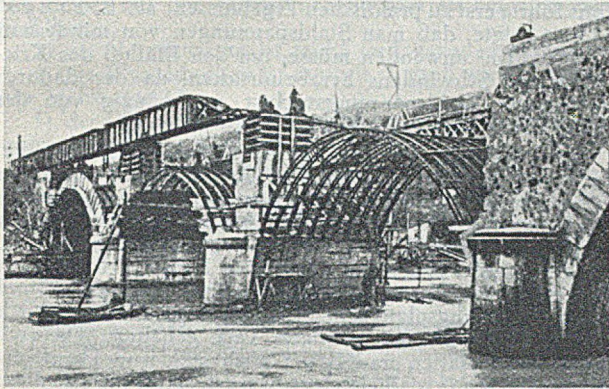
Eingebautes Lehrgerüst der Brücke bei Saussoy.
